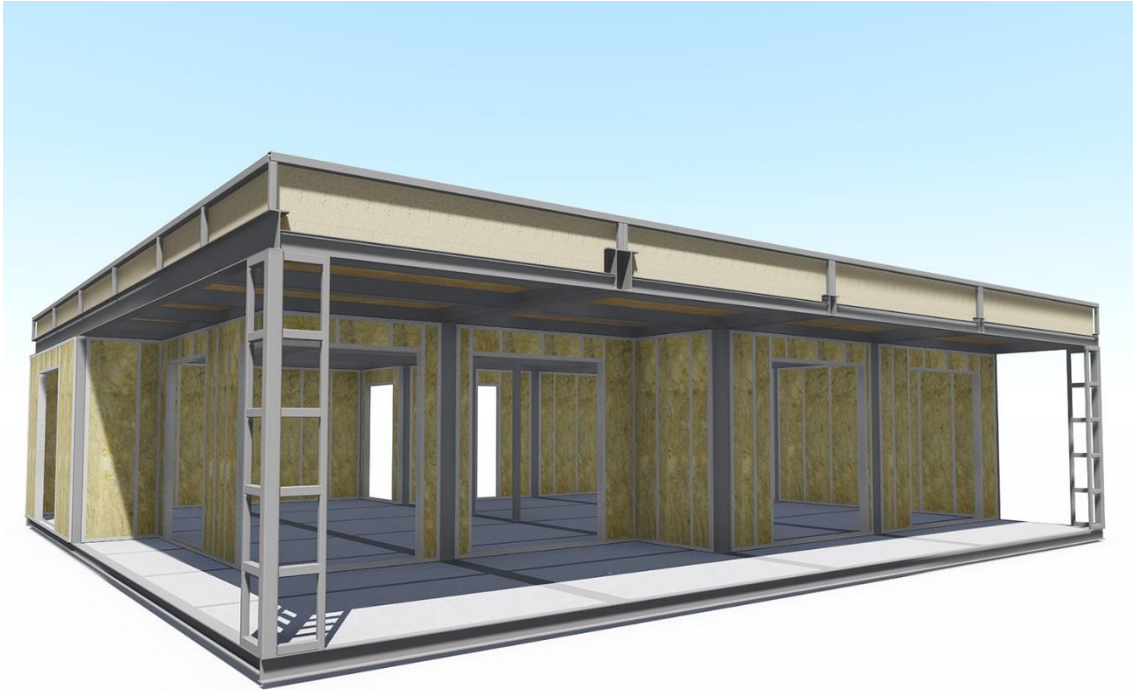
Estructura de acero con cubierta. Fuente: Empresa Hauss Modular.
